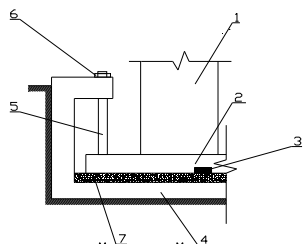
Фундамент сейсмостойкого здания. 1- здание; 2- плита; 3- датчик давления (мессдоза); 4- внешний фундамент; 5- тросы жесткой подвески; 6- гайки регулировки давления; 7- песчаный слой
